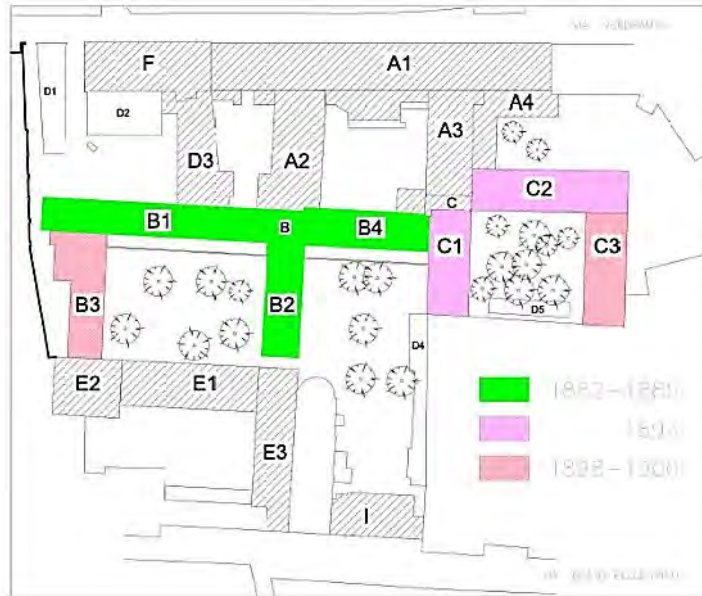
Planimetria originaria del complesso Ex Ospedale Geriatrico
